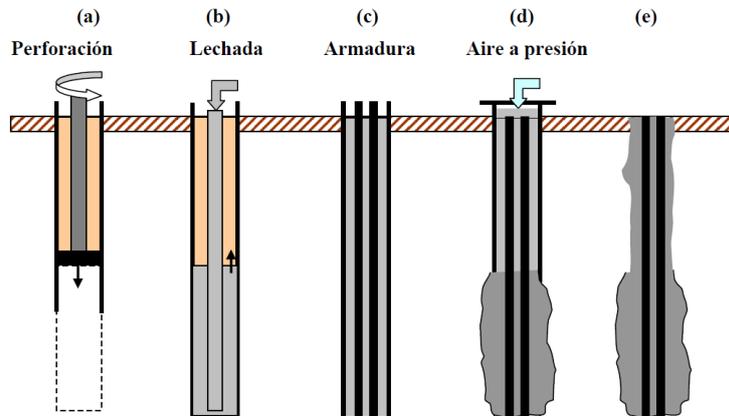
a) Perforación con sistema rotario y encamisado de la perforación. b) Llenado de la perforación con lechada de cemento por desplazamiento de los barros. c) Colocación de las armaduras.
